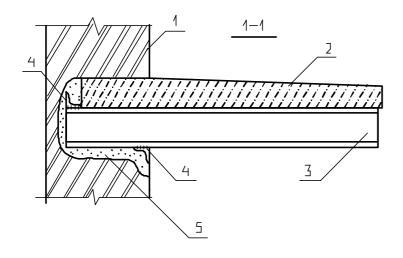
Усиление балконной плиты путем подведения консолей из прокатного материала 1 — стена; 2 — балконная плита; 3 — консоль из прокатного металла (двутавр, швеллер); 4 — опорный уголок-подкладка; 5 — ниша в стене (после установки балок заполняется бето-
